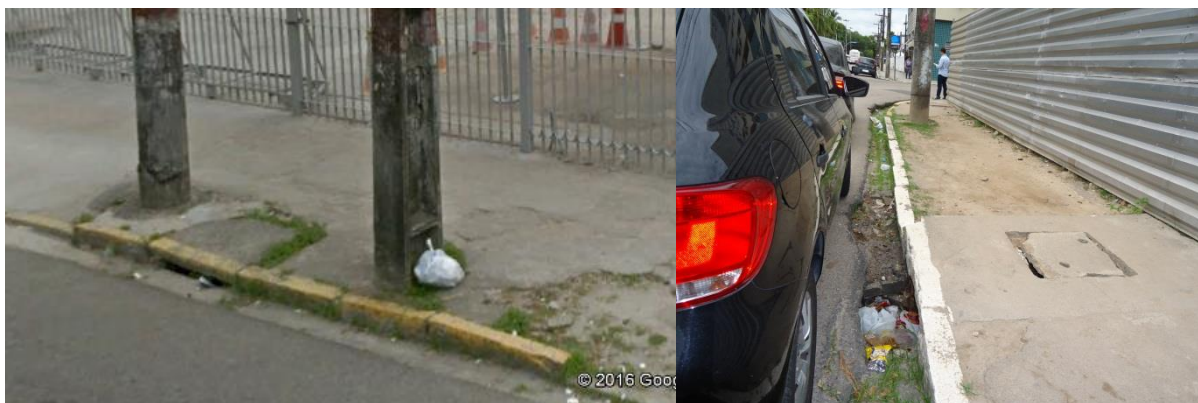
Situação Atual: Caixas tipo gaveta e boca-de-lobo obstruídas. E linha d' água obstruída por vegetação e lixo.
